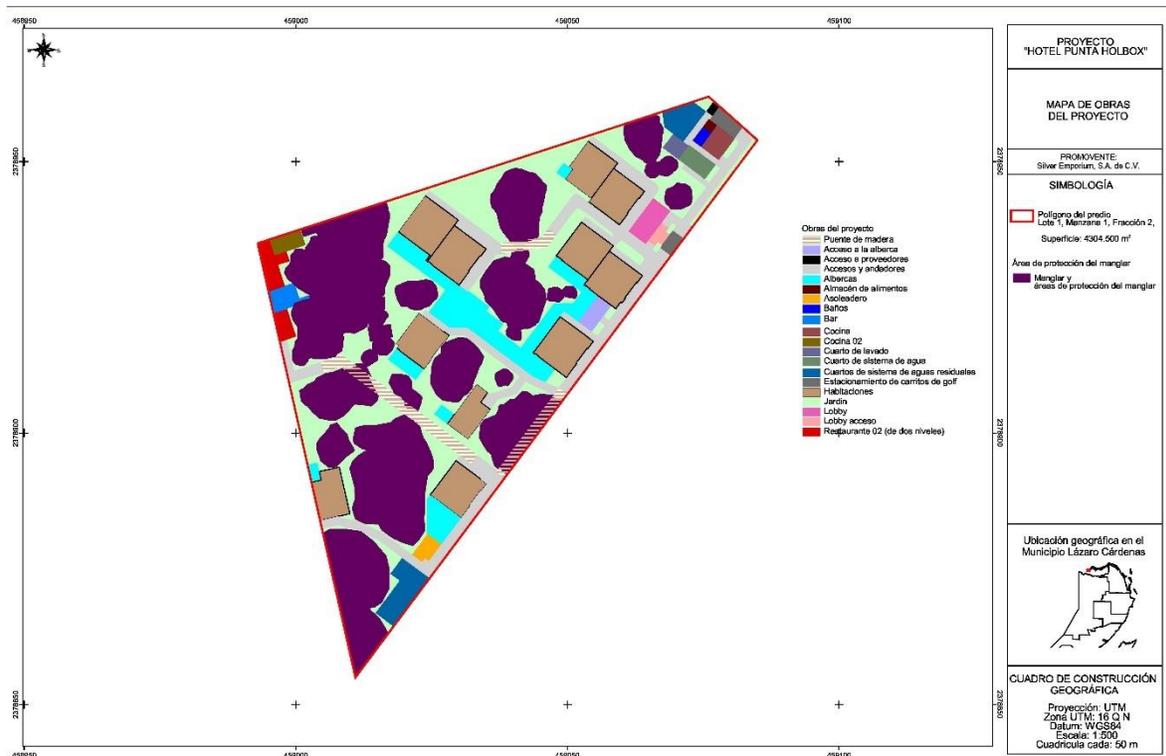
Plano de conjunto del proyecto “Hotel Punta Holbox”
